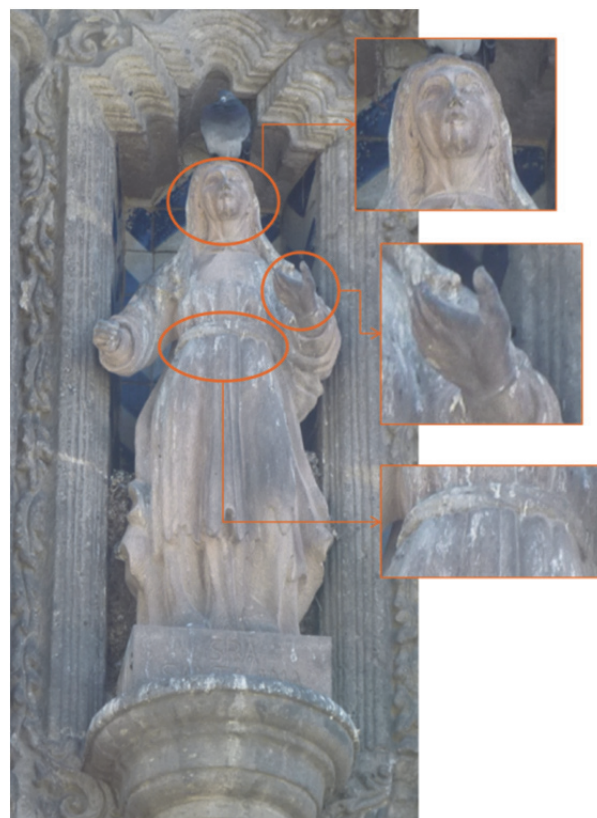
Detalle de la figura de Santa Ana en el lado sur del cuerpo superior de la fachada principal.
